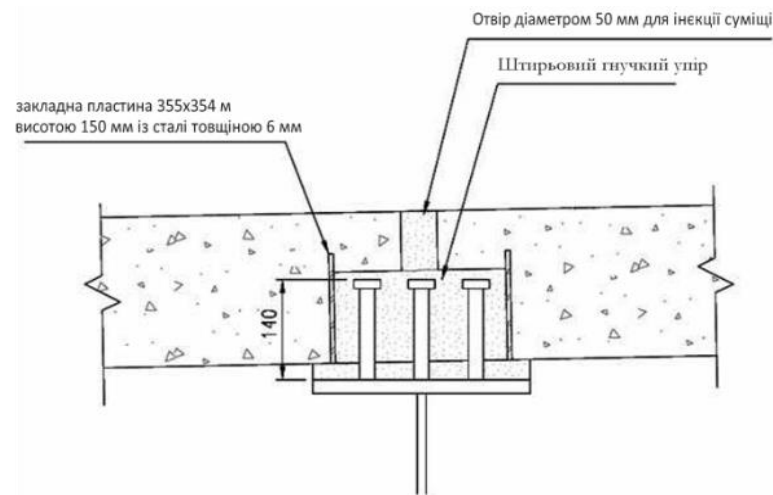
Варіант поєднання залізобетонної плити та металевої балки
